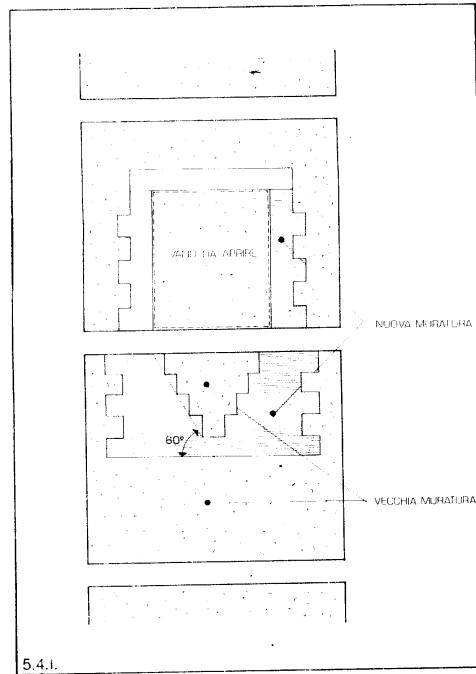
Rinforzo delle murature sottostanti ad un'apertura a strappo eseguita in un piano elevato.
